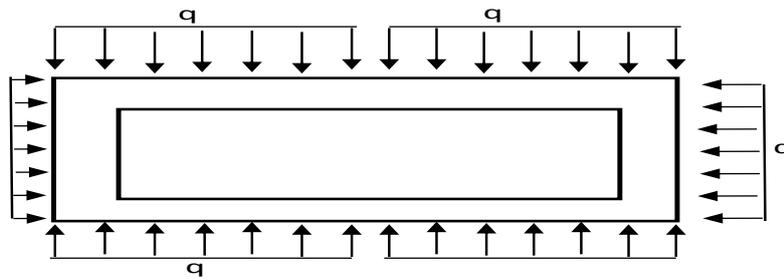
Schéma statique de la poussée des terres sur les voiles
